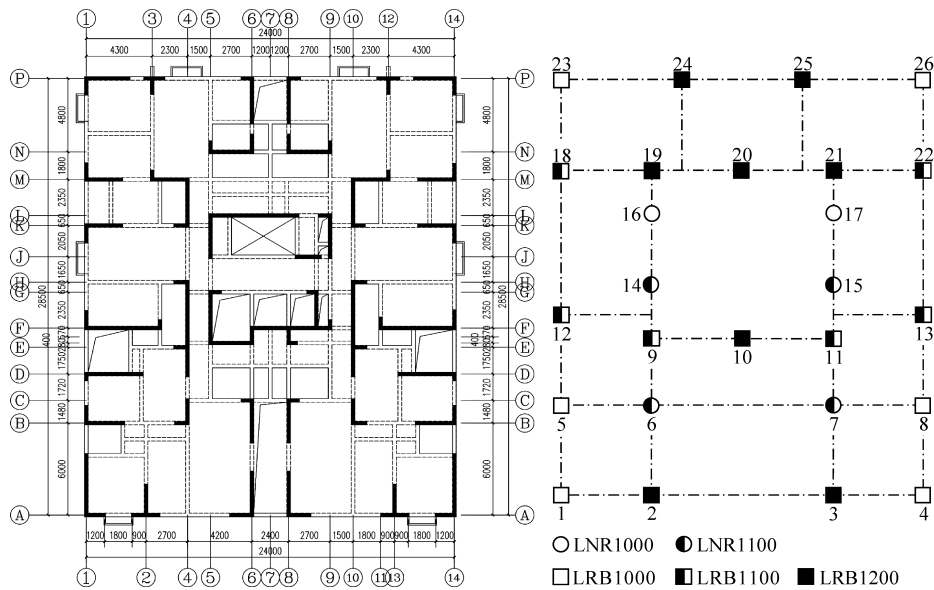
标准层结构平面图 (a) 及支座布置图 (b)
